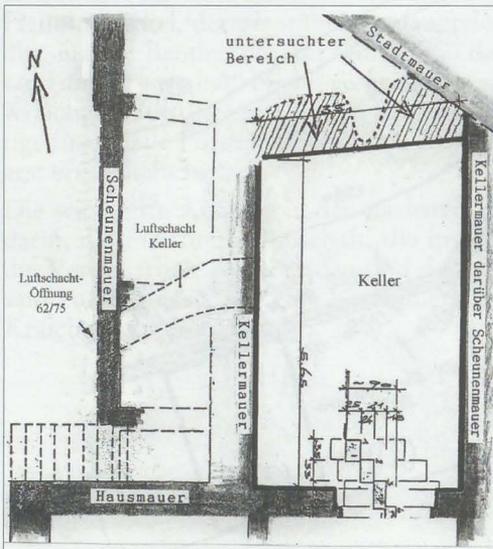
Grundriss des Kellers unter der Scheune mit dem untersuchten Bereich in der nördlichen Stirnwand
